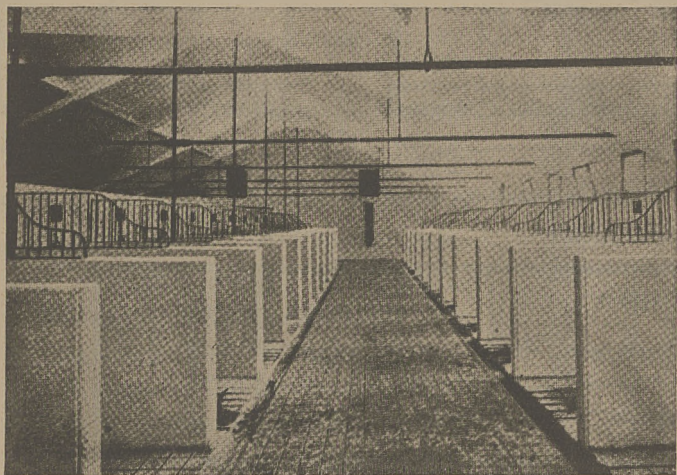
Posadzka piaskowa na podłożu betonowym.
